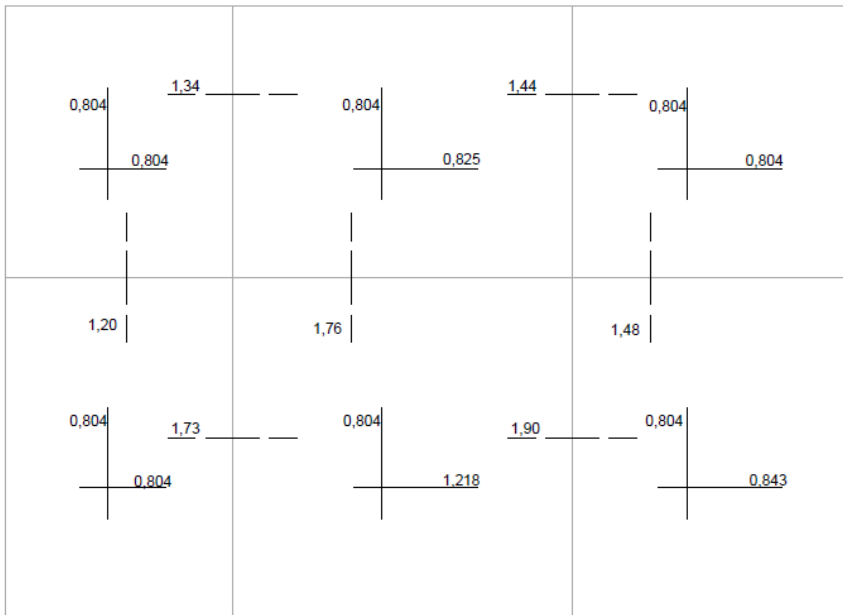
Armadura calculada para a solução alternativa do painel original (cm²/m)
